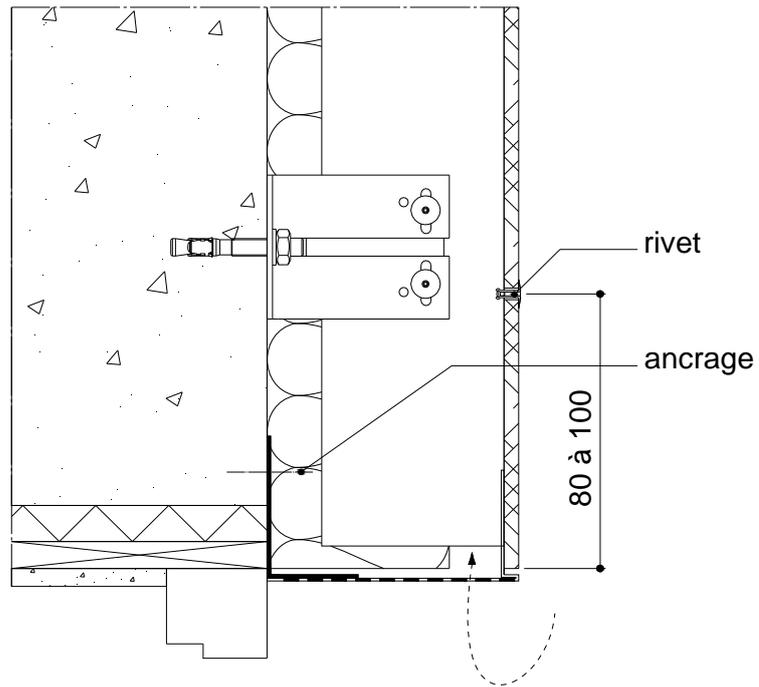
Détail linteau sur ossature métallique (cote en mm)
